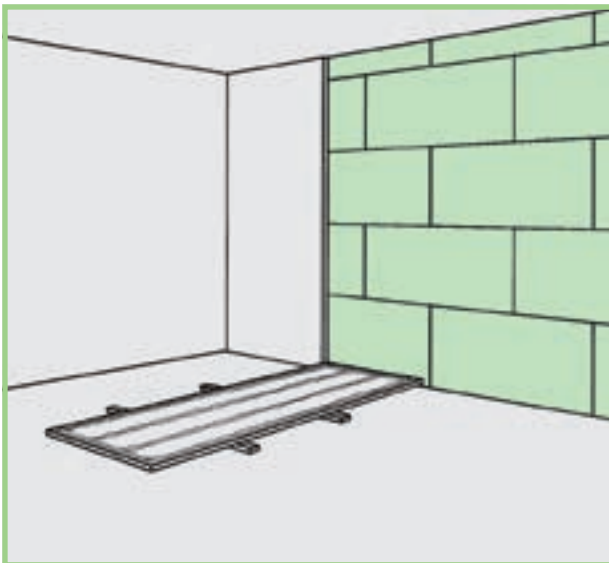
Imagen de adhesión de las planchas de cartón-yeso sobre Styrodur® C.
